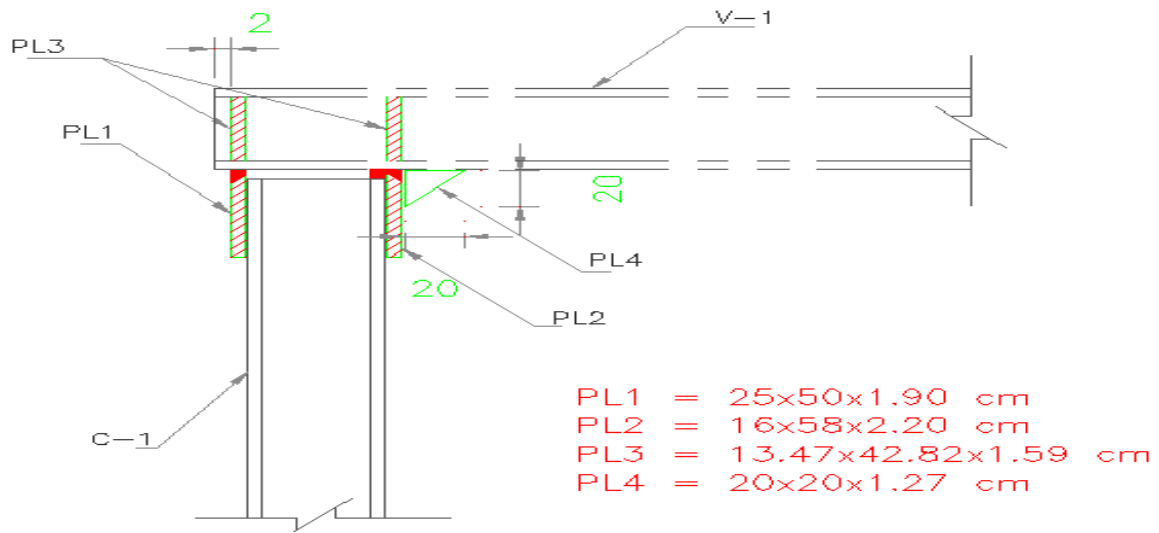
Conexión viga V-1 a columna C-1 (Placas)
